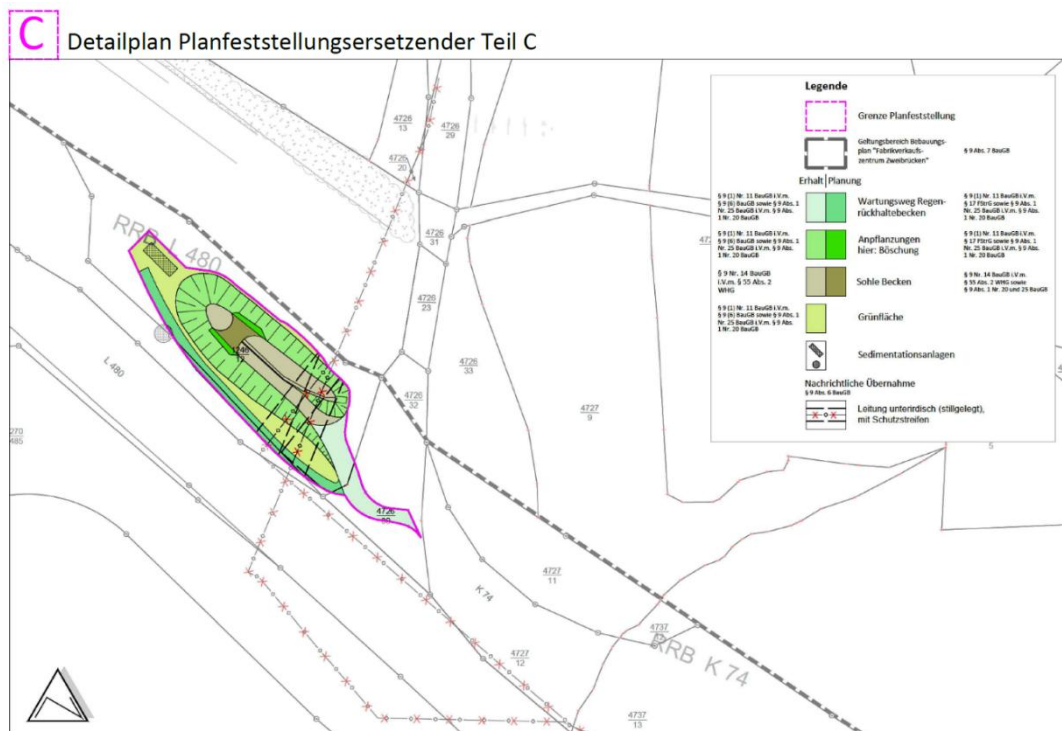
Zeichnerische Festsetzungen für den planfeststellungersetzenden Teilbereich C „RRB L480“ unmaßstäblich, FIRU mbH auf Grundlage Schönhofen Ingenieure, 2025.
